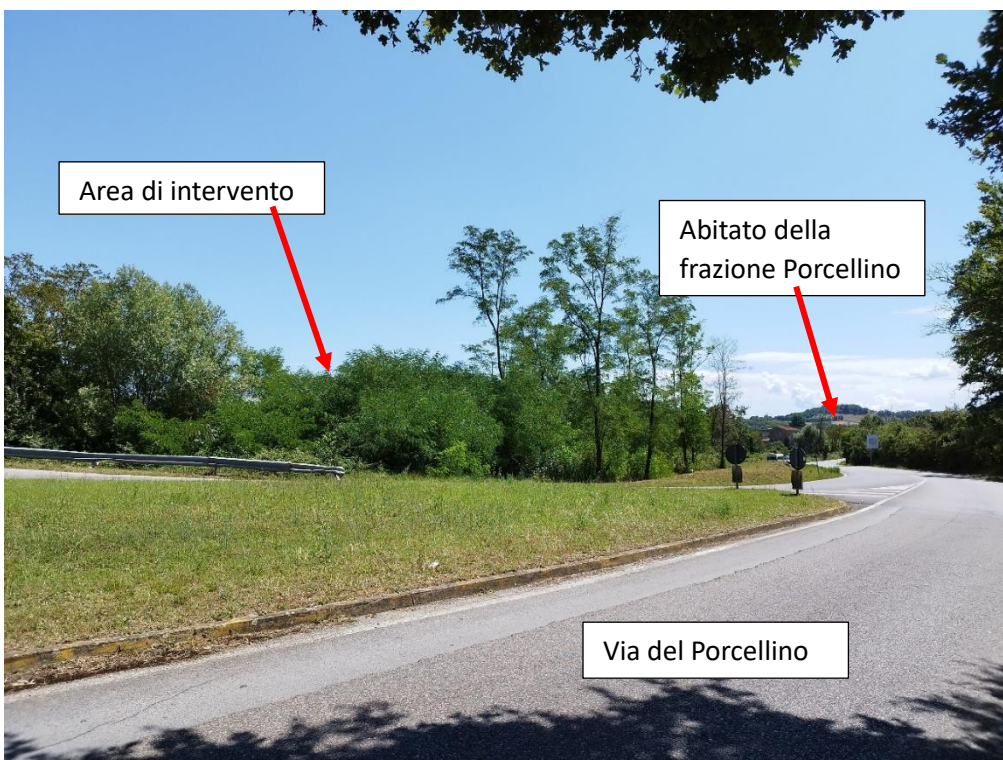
Vista dall'incrocio di Via del Porcellino con la SR 69
